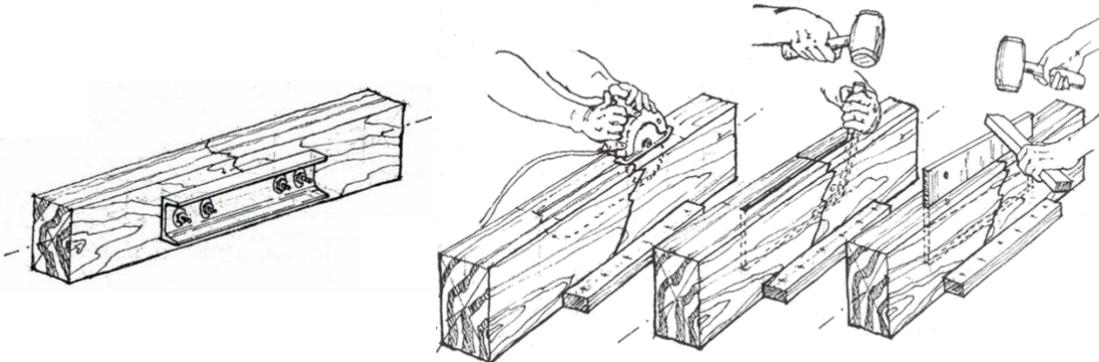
Ejemplos de refuerzos metálicos para piezas de madera.
